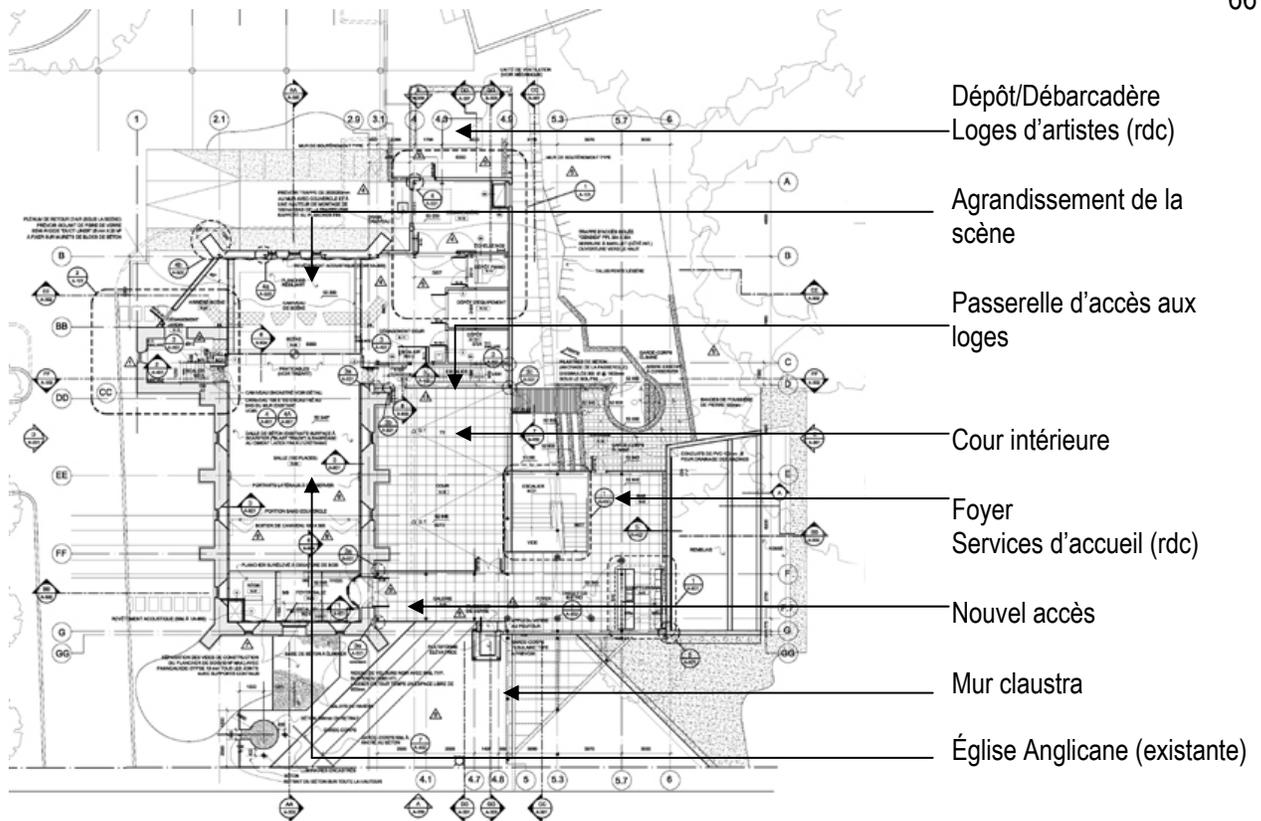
Plan de l'étage (Source: Dan S. Hanganu Architectes)
